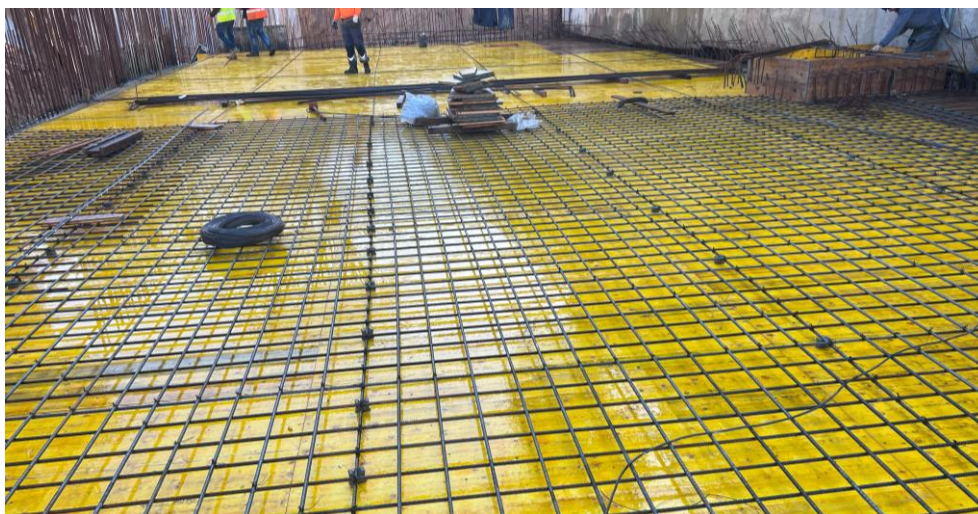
Colocação e amarração de armaduras inferiores de uma laje fungiforme aligeirada com moldes perdidos (Extraído de: Telhabel, 2023b)
